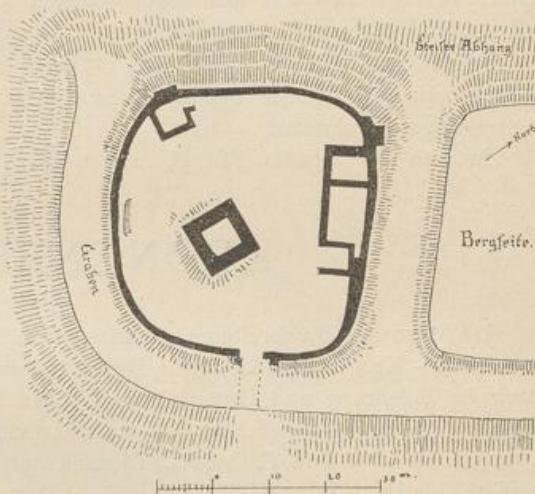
Hardenberg. Grundriss des alten Schlosses.
